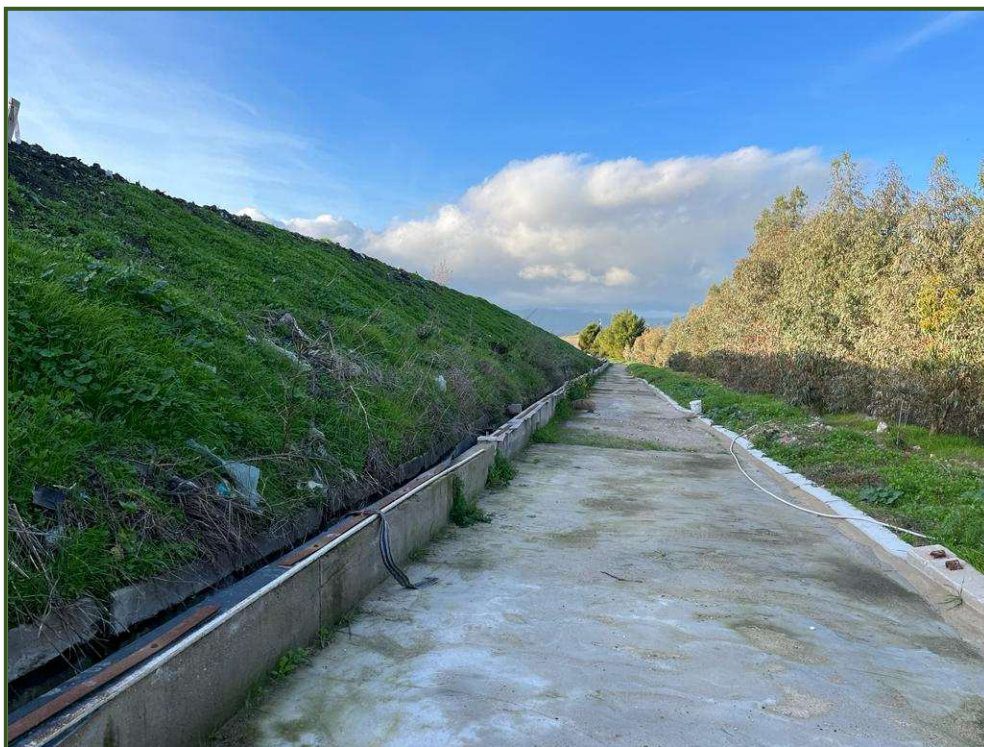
/V: Pavimentazione delle piste di servizio perimetrali alle vasche
